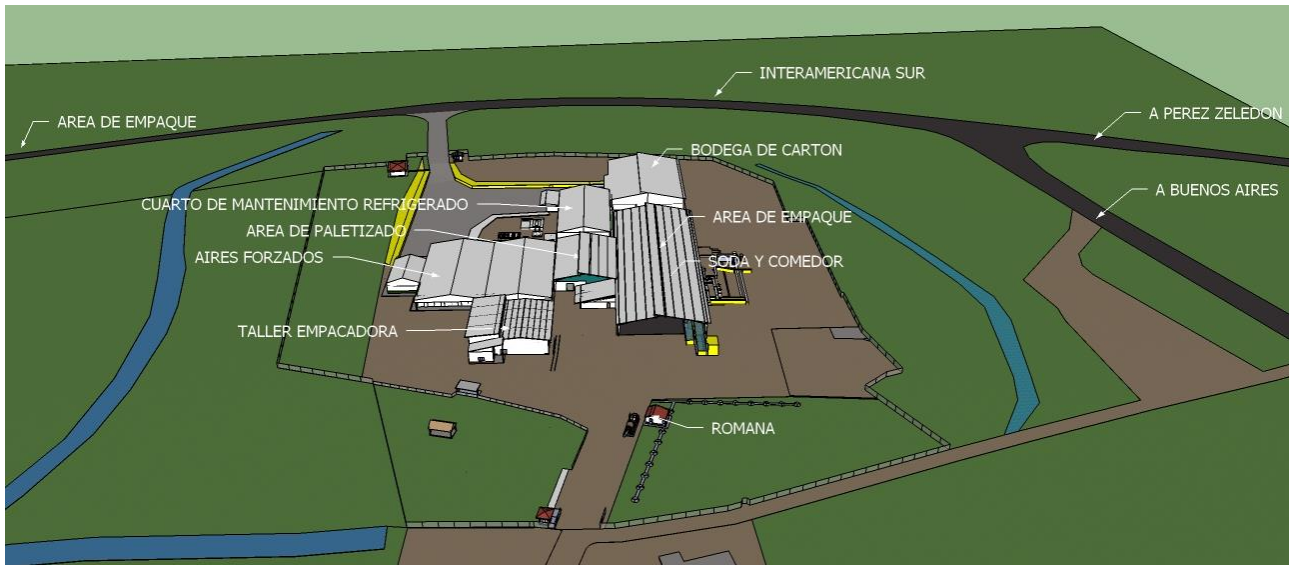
Detalle Diseño de Sitio Planta Empacadora de Piña actual.
